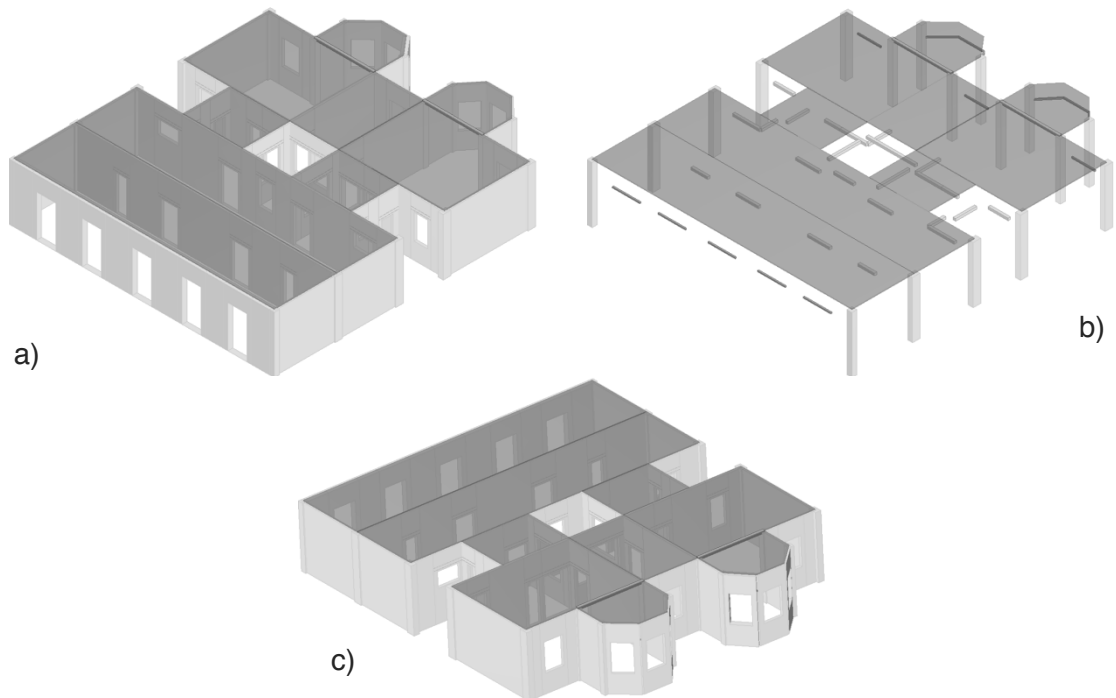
Modelo Tremuri edificio ED-02 planta tipo. a) Vista isométrica fachada principal. b) Vista isométrica fachada principal sin muros. c) Vista isométrica fachada trasera
